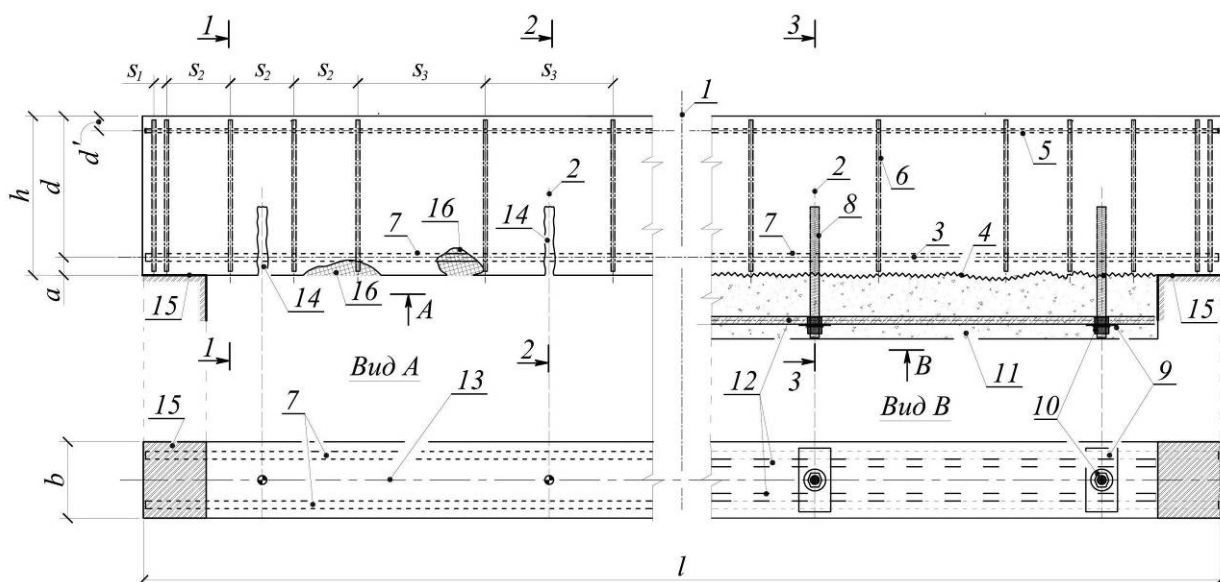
Спосіб посилення конструкції шляхом улаштування залізобетонного каркасу із введенням додаткових арматурних зв'язків
